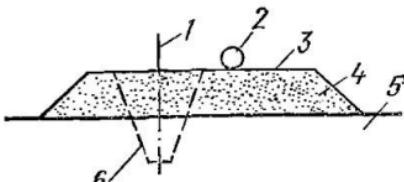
Переход через болото трубопроводом, укладываемым в пионерной насыпи
